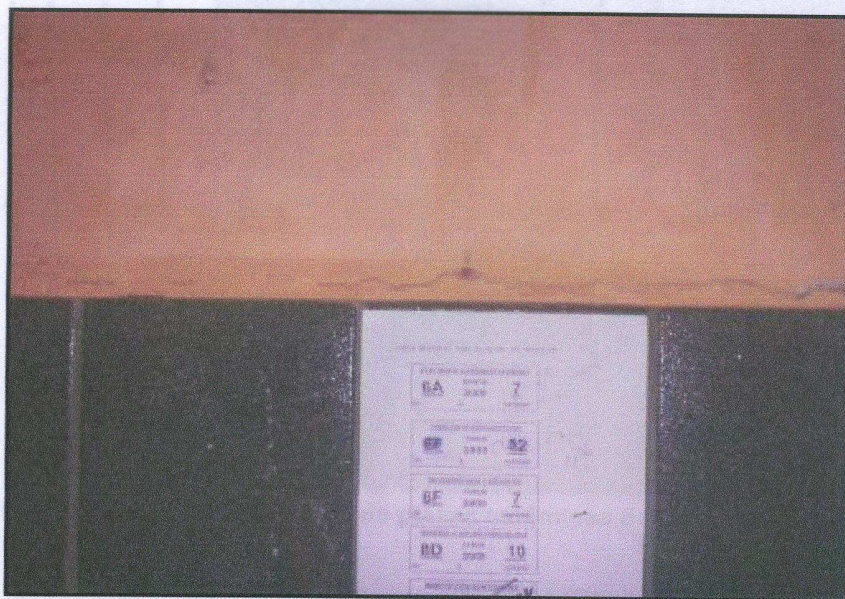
96 – Fissura horizontal na parede das salas.
